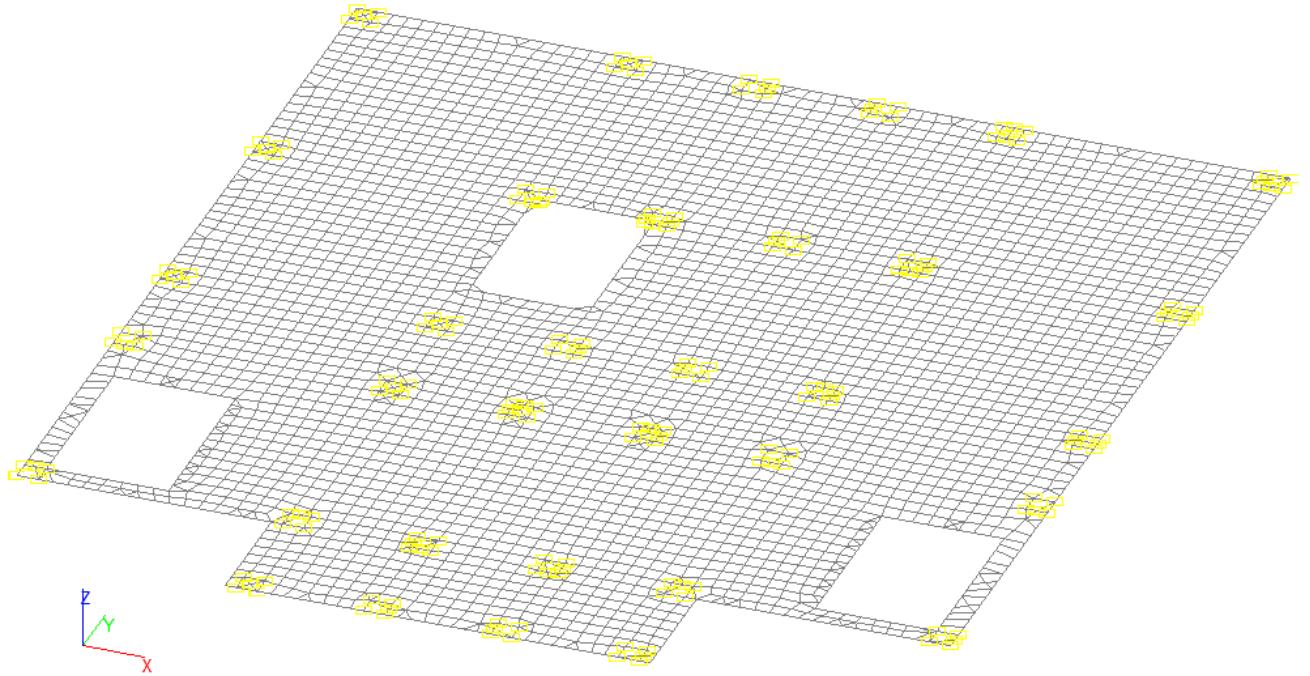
Расчётная схема плиты перекрытия в плоскости:
